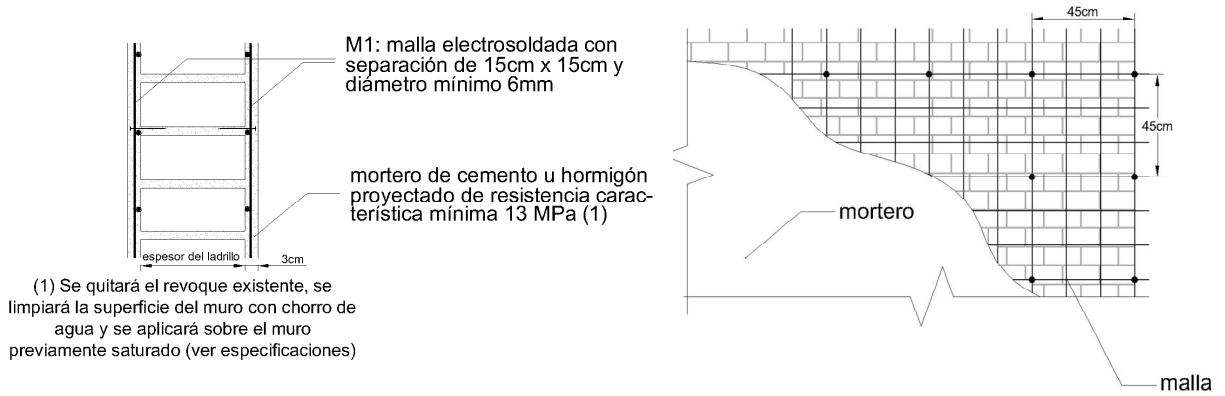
Detalles de malla M1 y su vinculación al muro a reforzar.
